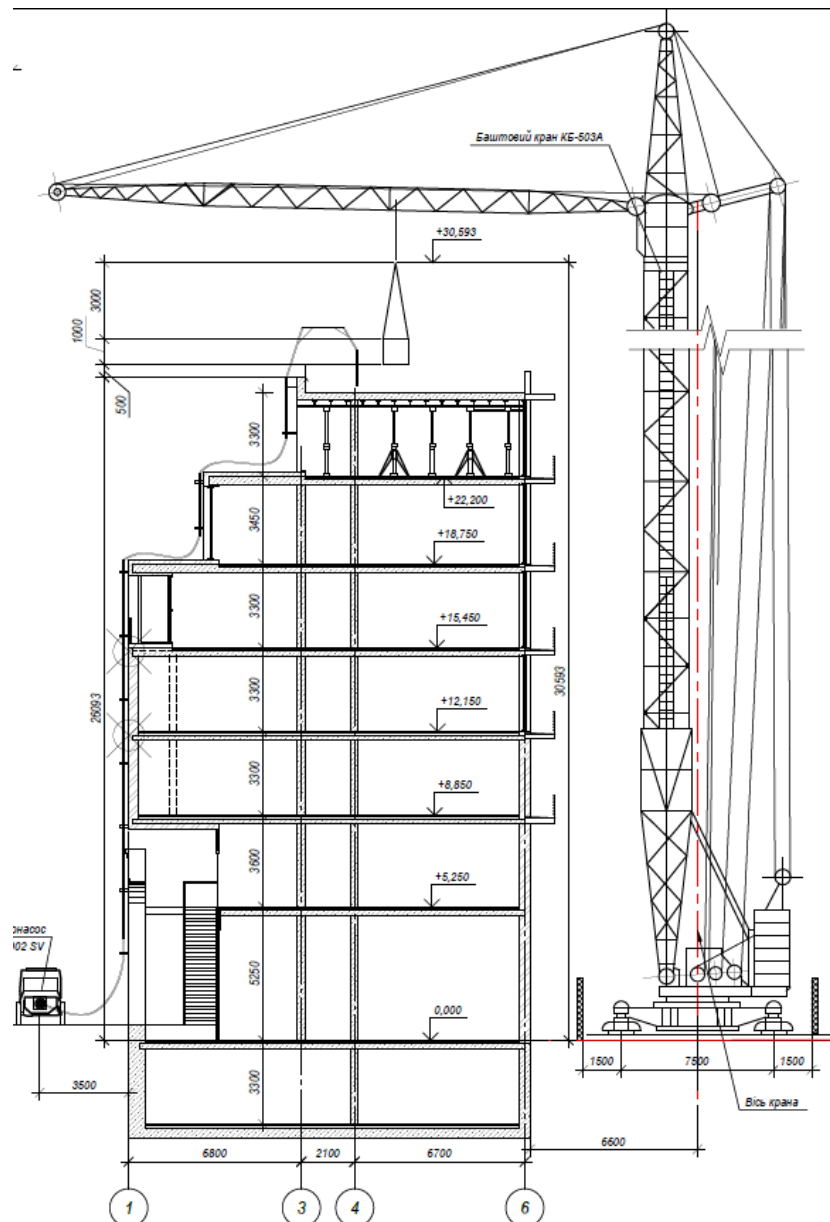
Схема розміщення баштового крану KB503A біля будівлі та схема владання бетонної суміші в опалубку перекриття
